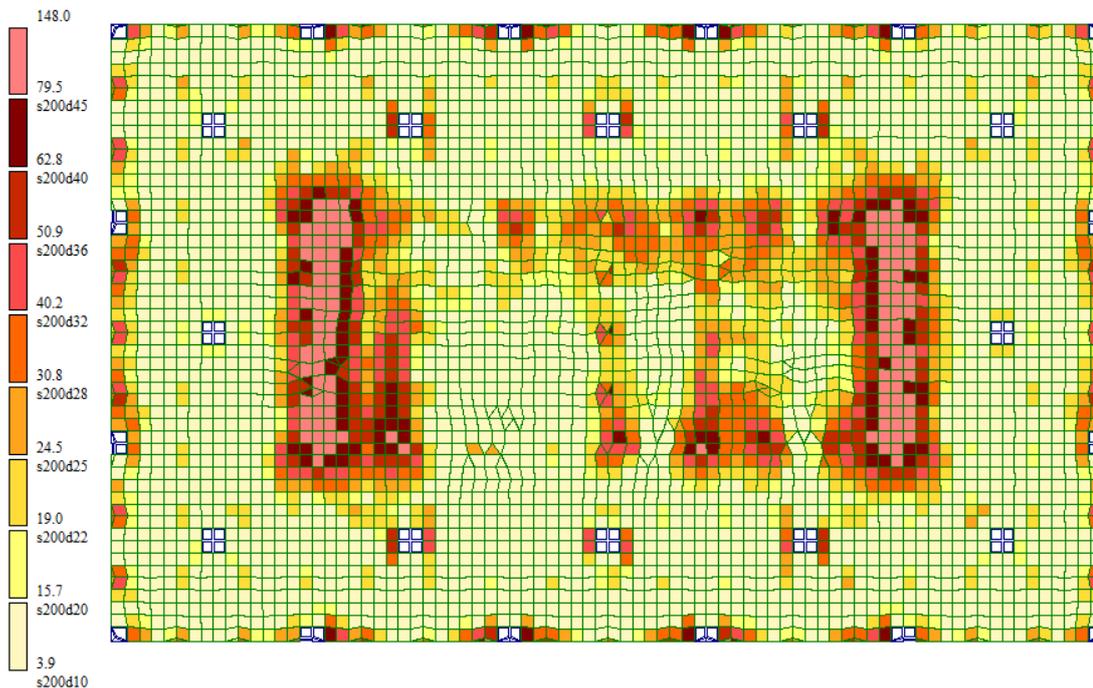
Схема армирования низа фундаментной плиты по оси OX
